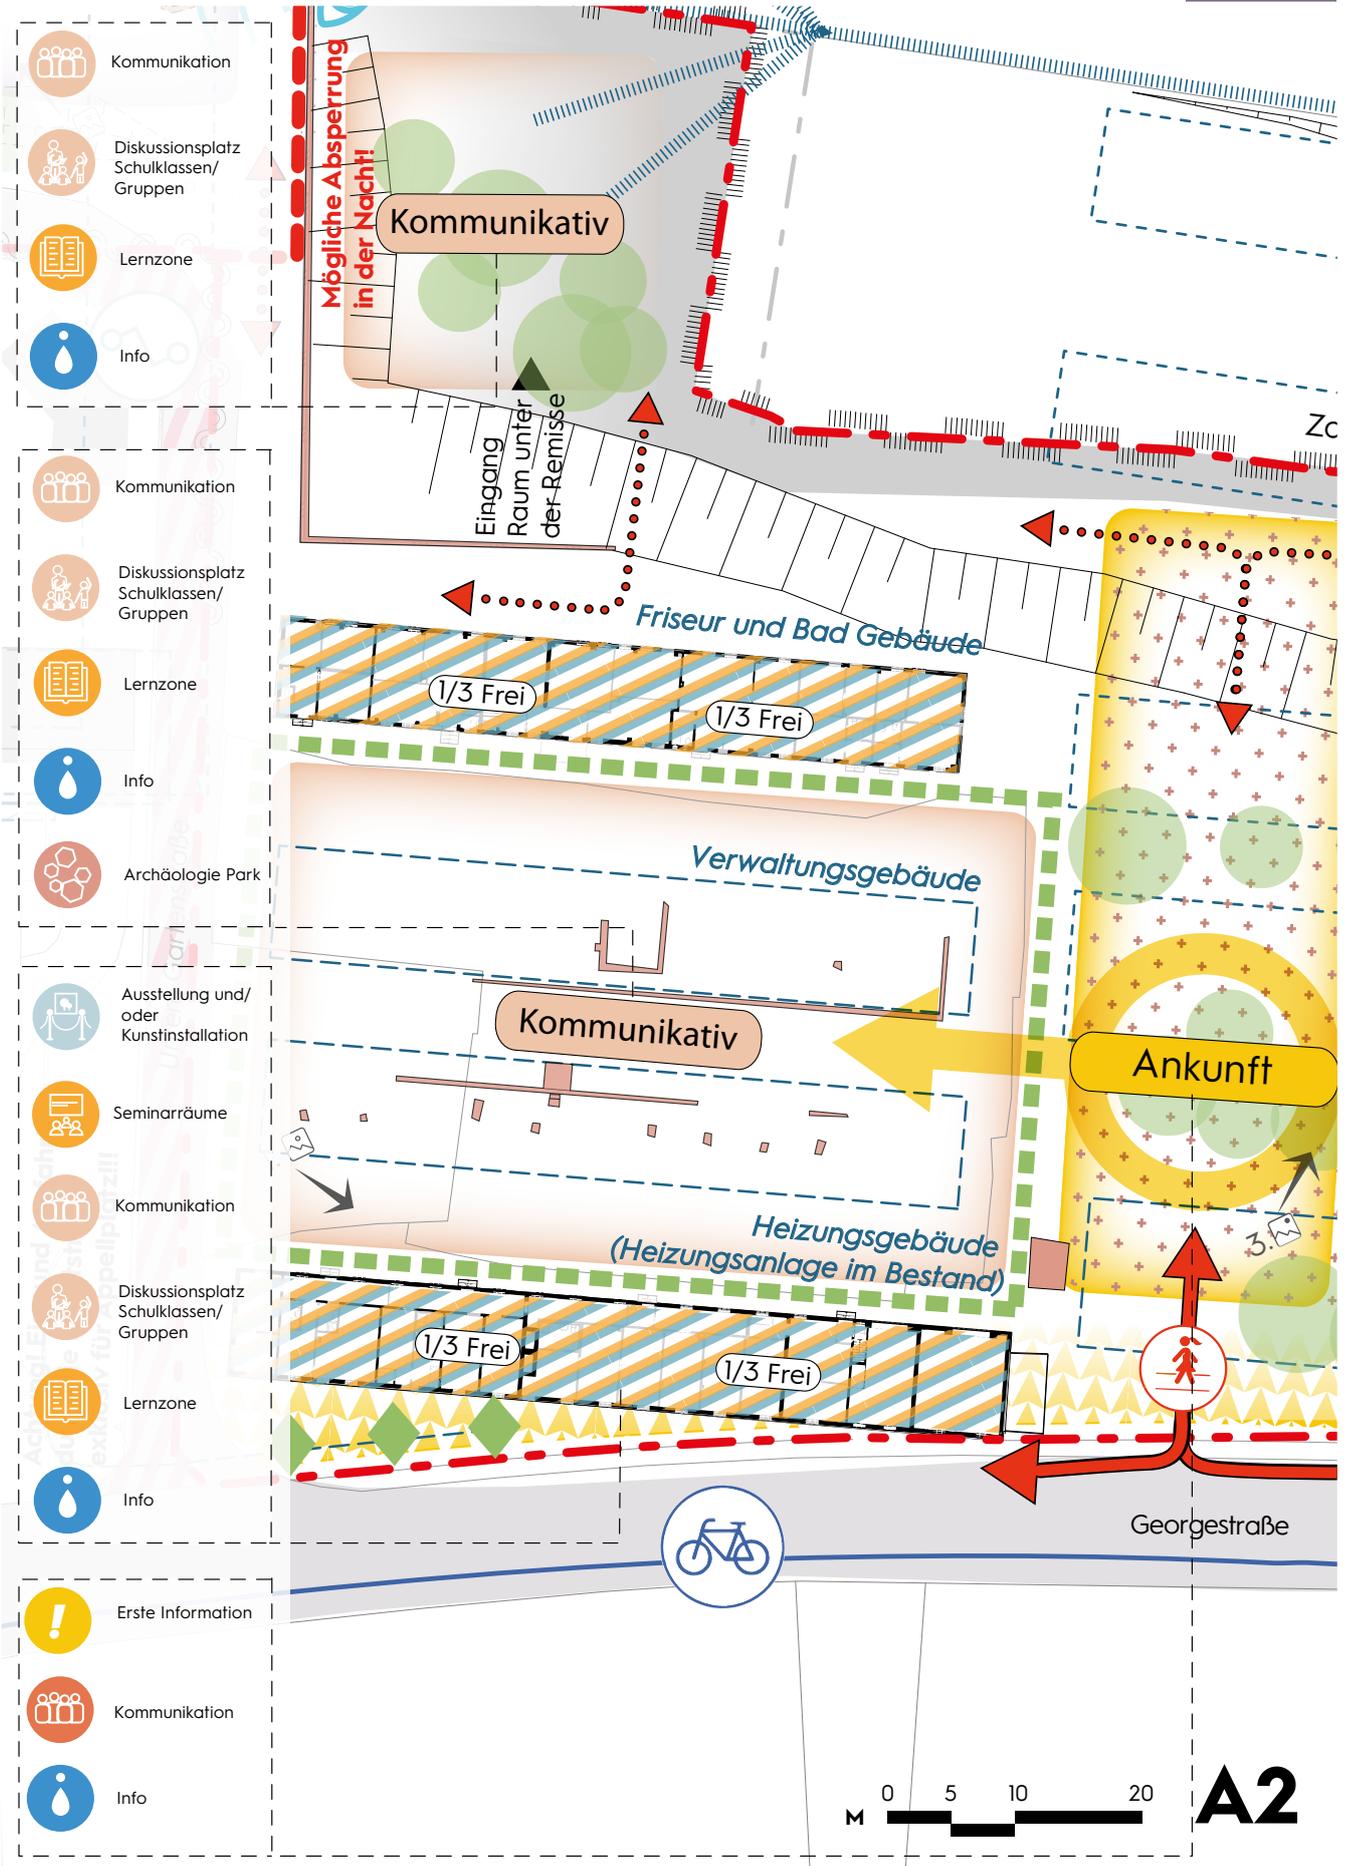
Masterplan Grundriss Appellplatz (Ausschnitt A2)
